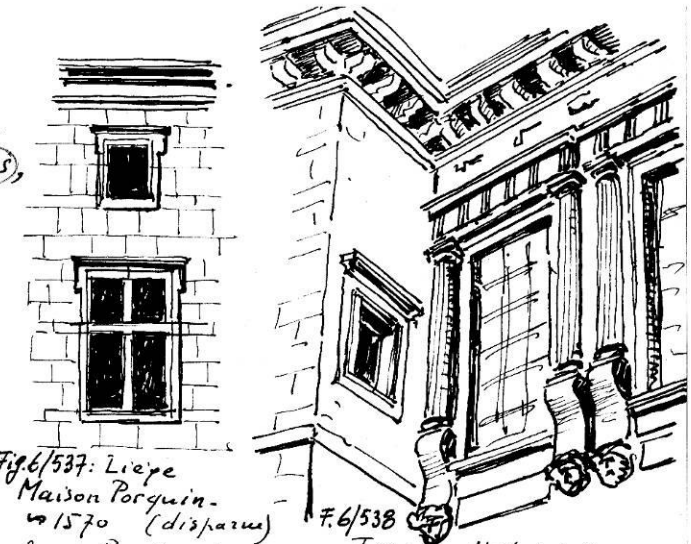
/537: Liège Maison Porquin. 1570 (disparue) fen. à chambranle à voiles et croisée de pierre (élément autochtone)
